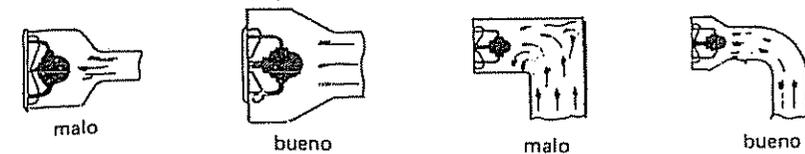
VI. Detalles buenos y malos de montaje de ventiladores helicoidales.
